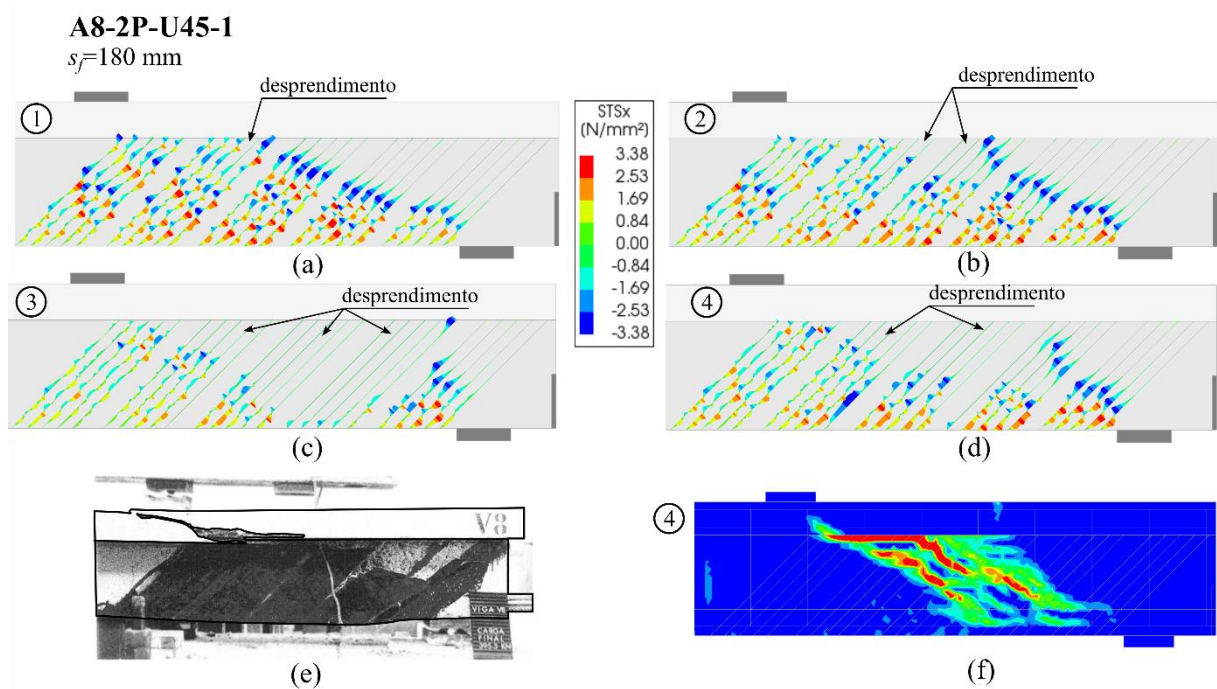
Tensões de aderência entre concreto e FRP para a viga A8-2P-U45-1.
